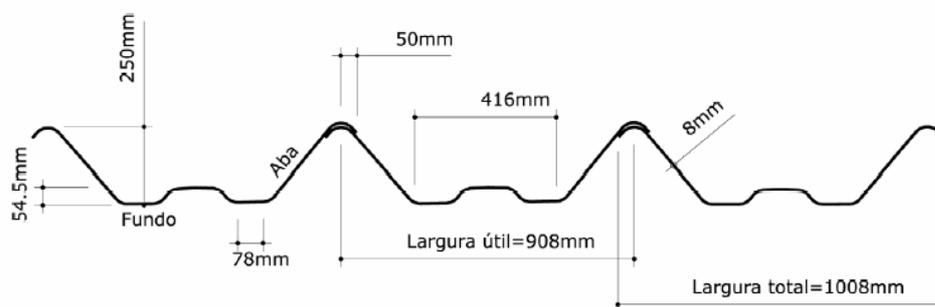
Seção transversal – telha tipo Canaleta 90. Fonte: ETERNIT, 2007.
